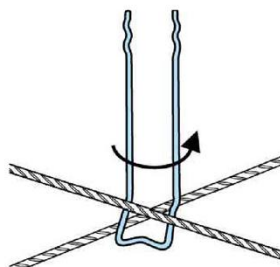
Anstecknadel nach links über unteren Bewehrungsstab drehen.
